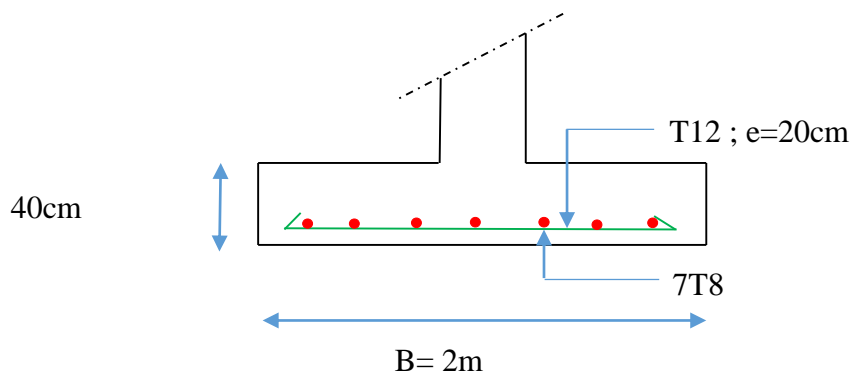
Schéma de ferrailage de la semelle suivant X-X
